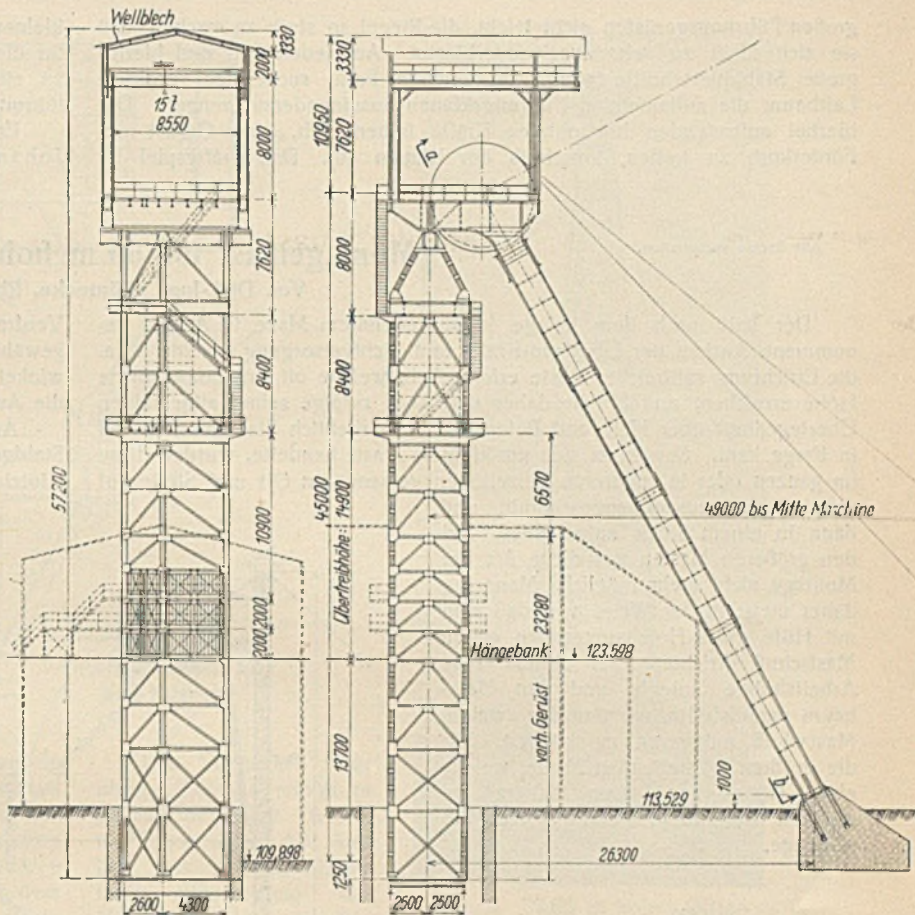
Fördergerüst Schacht Arnold der Großschachtanlage „Robert Müser“. Querschnitt und Ansicht.
